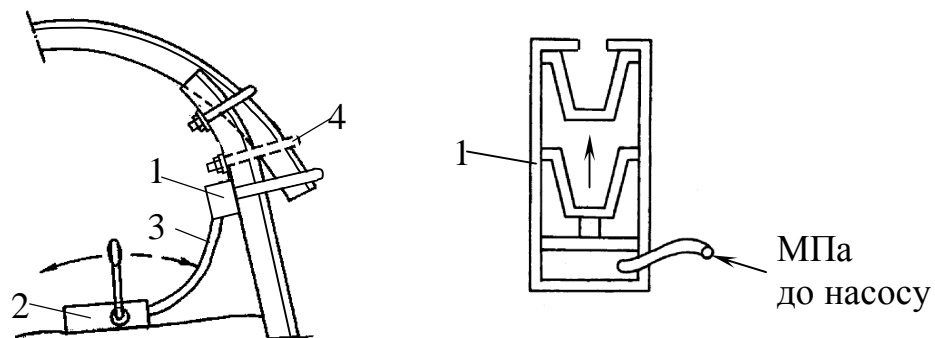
Відновлення опору замкового з'єднання податливого кріплення шляхом часткового стягування верхняка зі стояком та встановлення нового хомути (скоби, планки й гайки): 1 – стяжний гідравлічний пристрій, 2 – ручний насос, 3 – високонапірний гнучкий шланг, 4- новий установлюваний хомут
